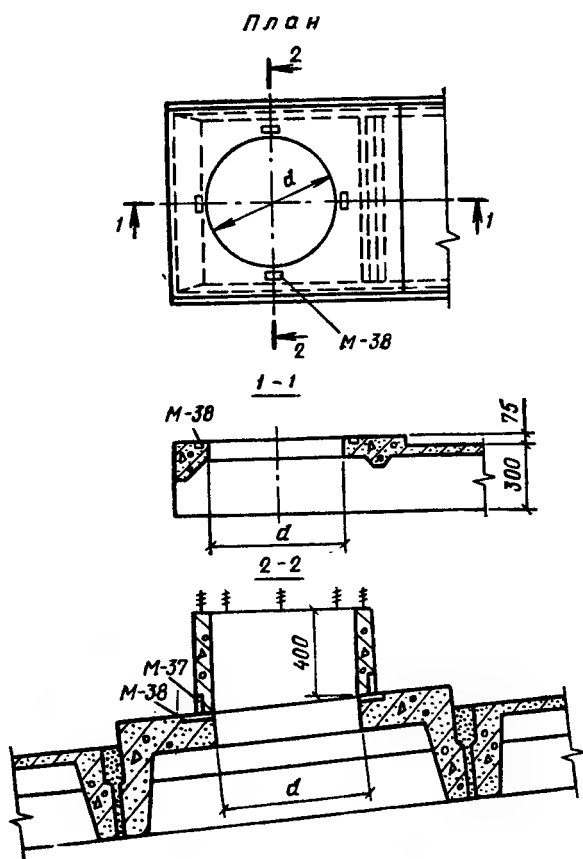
Деталь устройства круглого отверстия (в плите 1,5x6 м)
